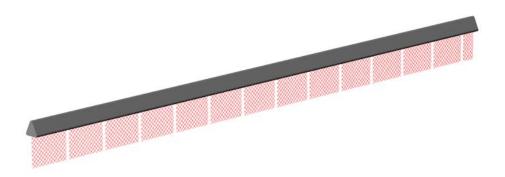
Stremaform Spacer mit dreieckigem Faserbetonabstandhalter
